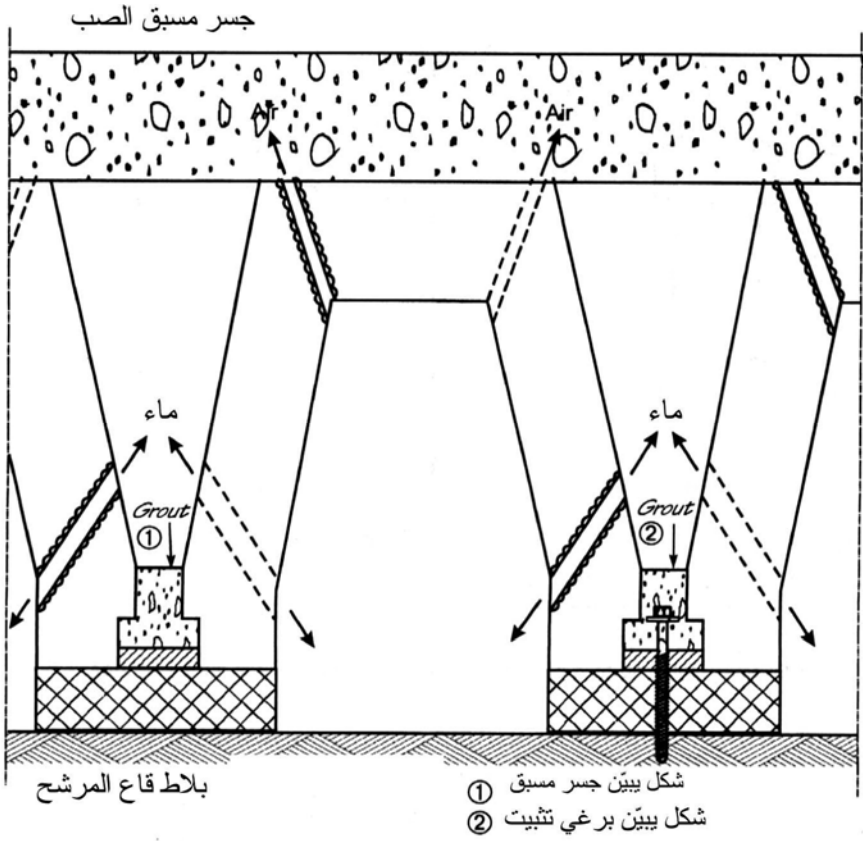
مسقط أفقي لقاع مرشح متموج واتجاه جريان مياه الغسيل العكسي
